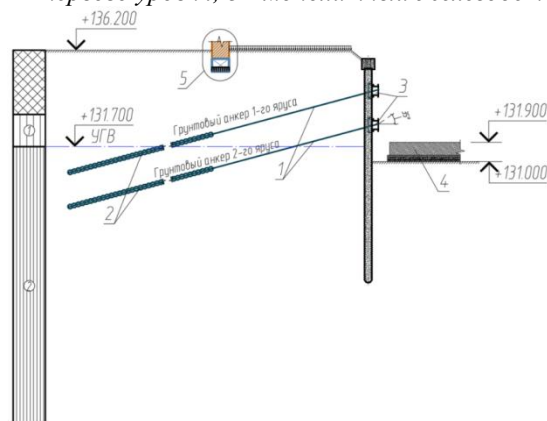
Характерный разрез ограждения котлована: 1, 2 - грунтовые анкера ЭРТ первого и второго уровней; 3 - стальные анкерные пояса; 4 – монолитный плитный фундамент строящегося 6 этажного объекта; 5 - фундамент одного из зданий существующей застройки.
